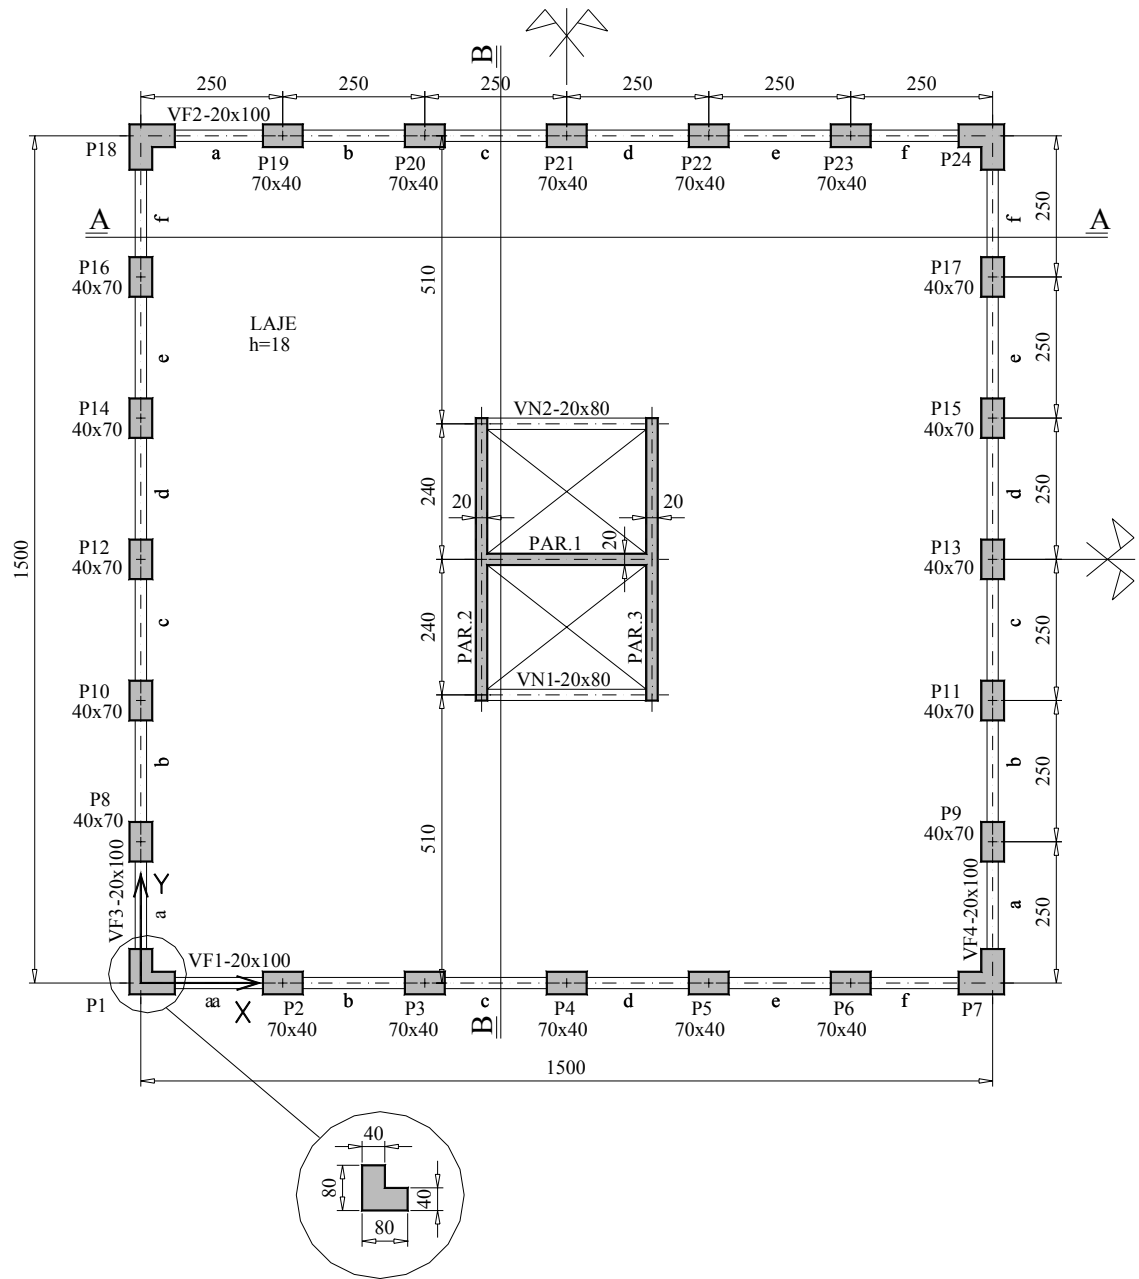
Planta do 6º ao 10º andar (cotas em centímetros)
